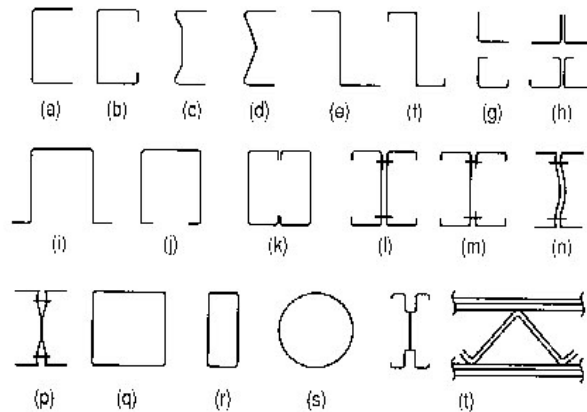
Seções transversais de perfis de chapa dobrada e ou soldados.
